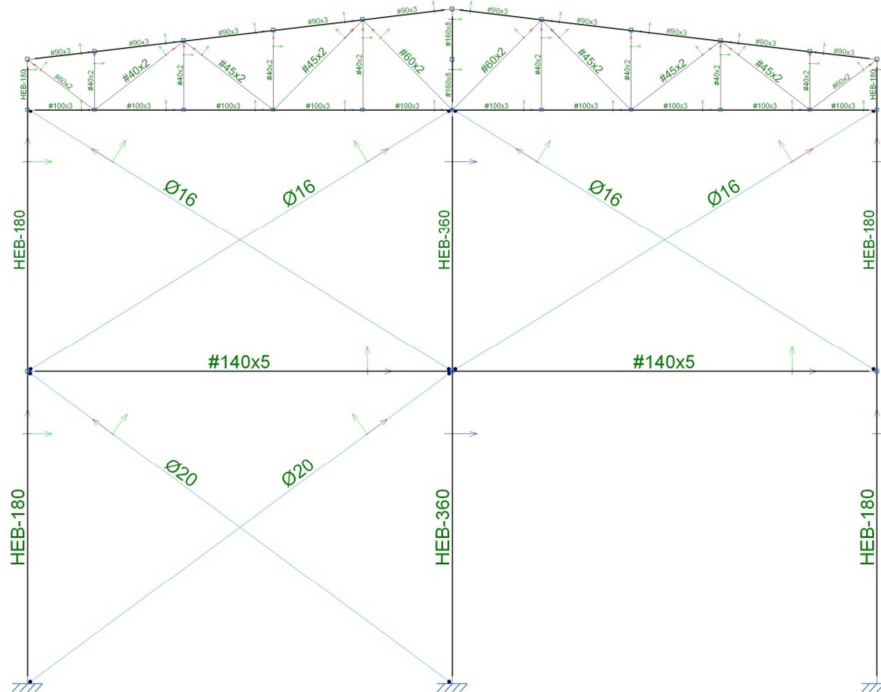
Pórtico de celosía de fachada con tirantes en fachada y cubierta
